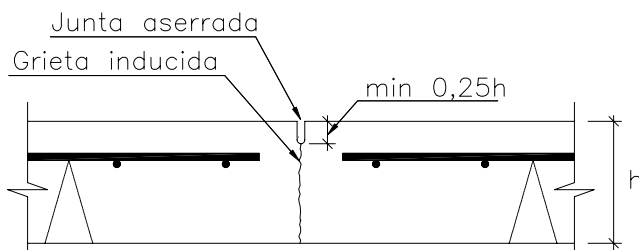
Aserrado de junta en una losa de hormigón.
